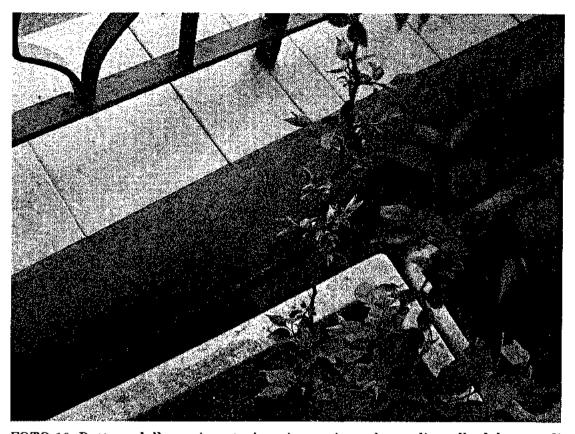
Rottura della pavimentazione in corrispondenza di quella del muro di sostegno al confine con il parcheggio condominiale
